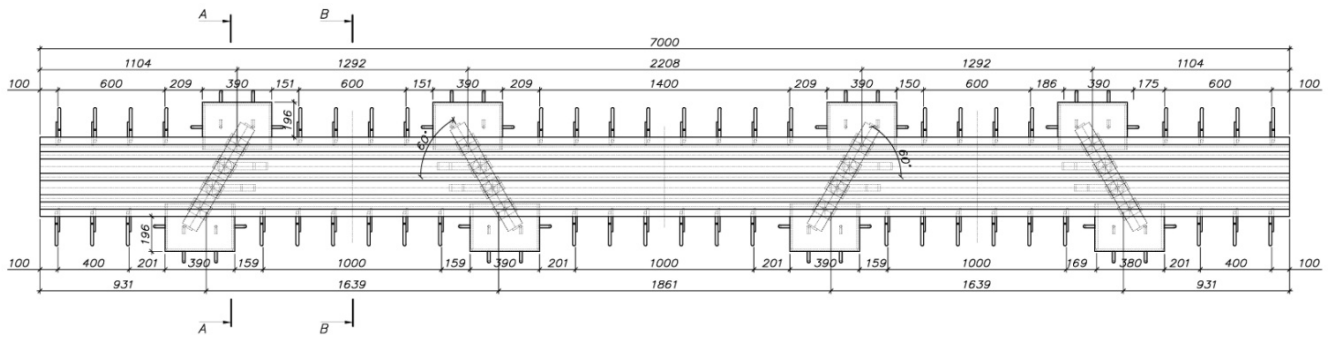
Пример МПДШ со сварными траверсами (сечение)
